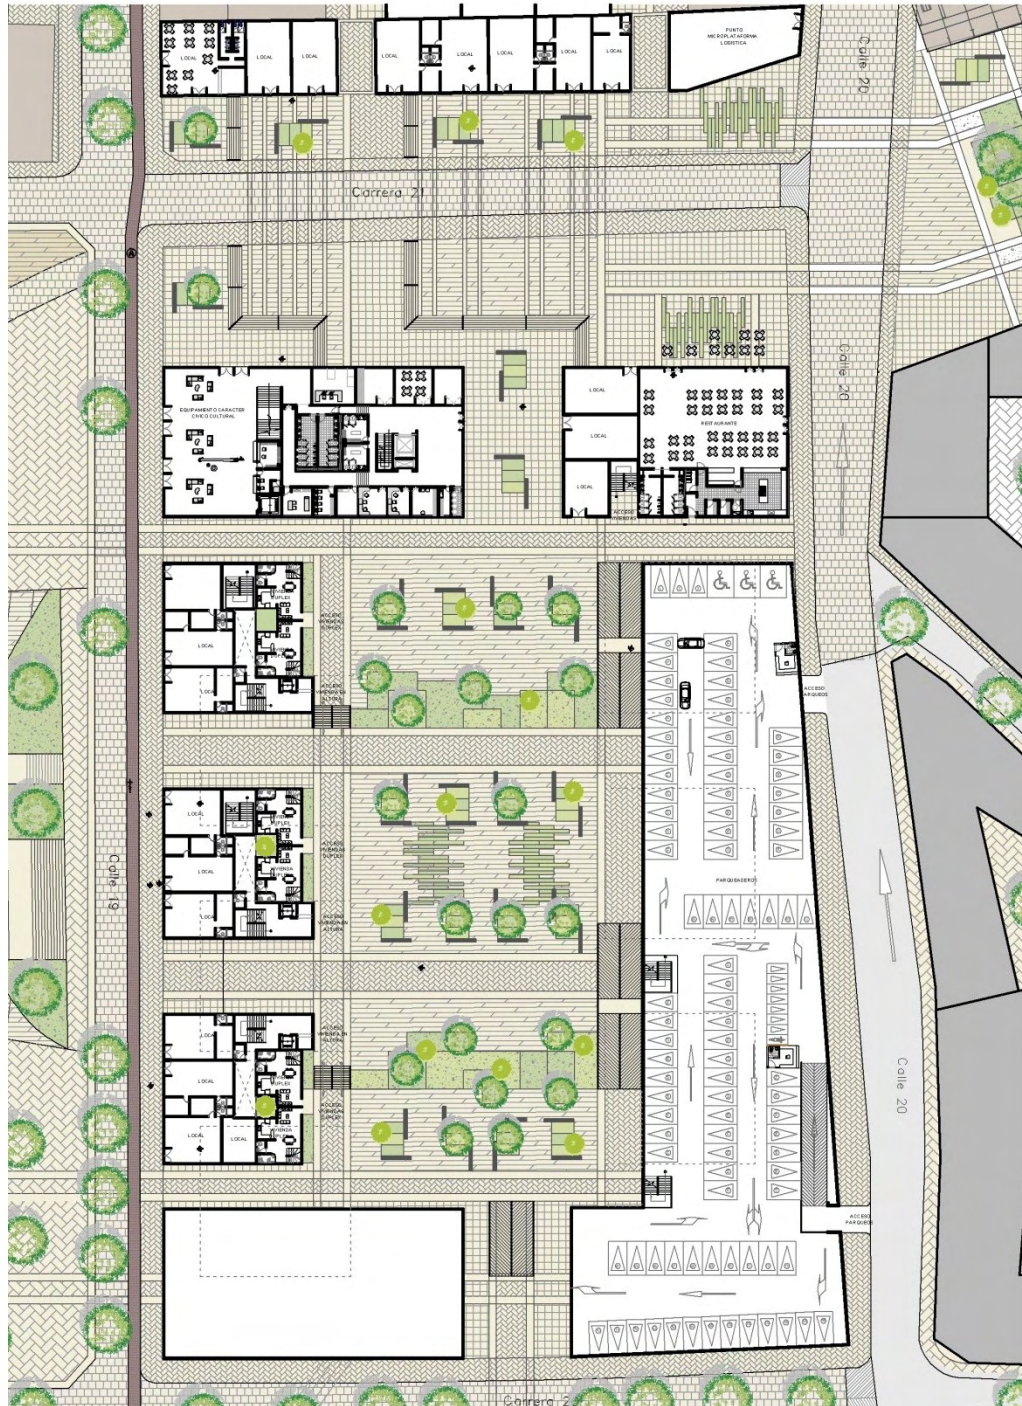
Planta general Primer piso entre calles 19y 20 y carrera 20 y 21.
